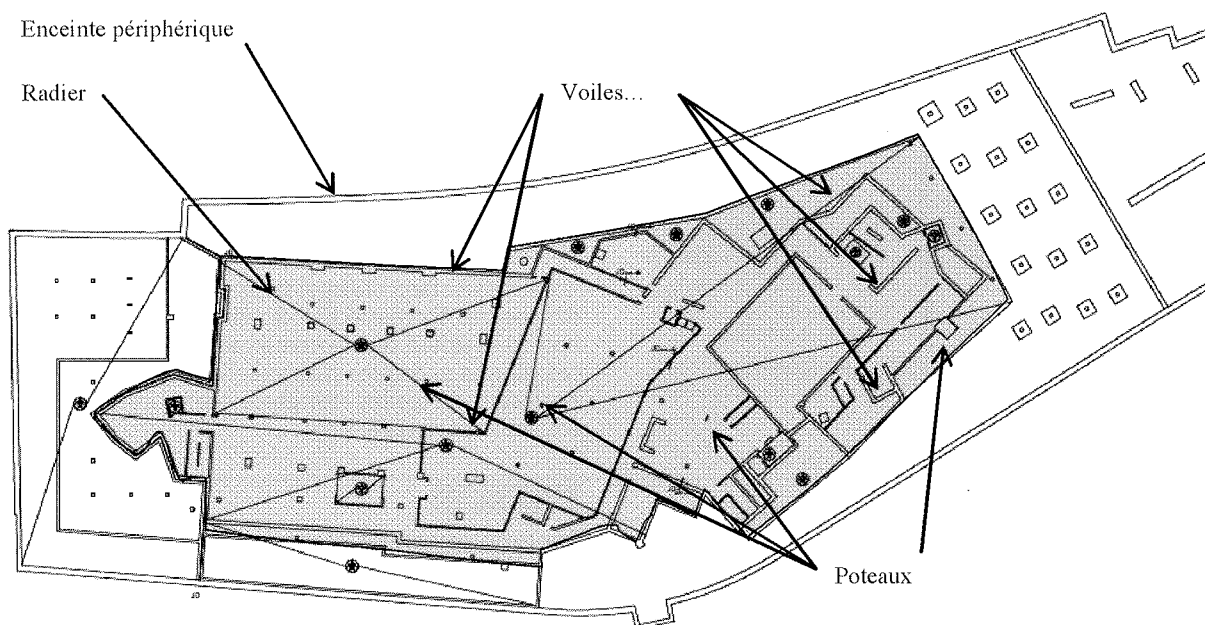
Vue en plan de la Fondation : localisation des porteurs de charge en face supérieure du radier.
